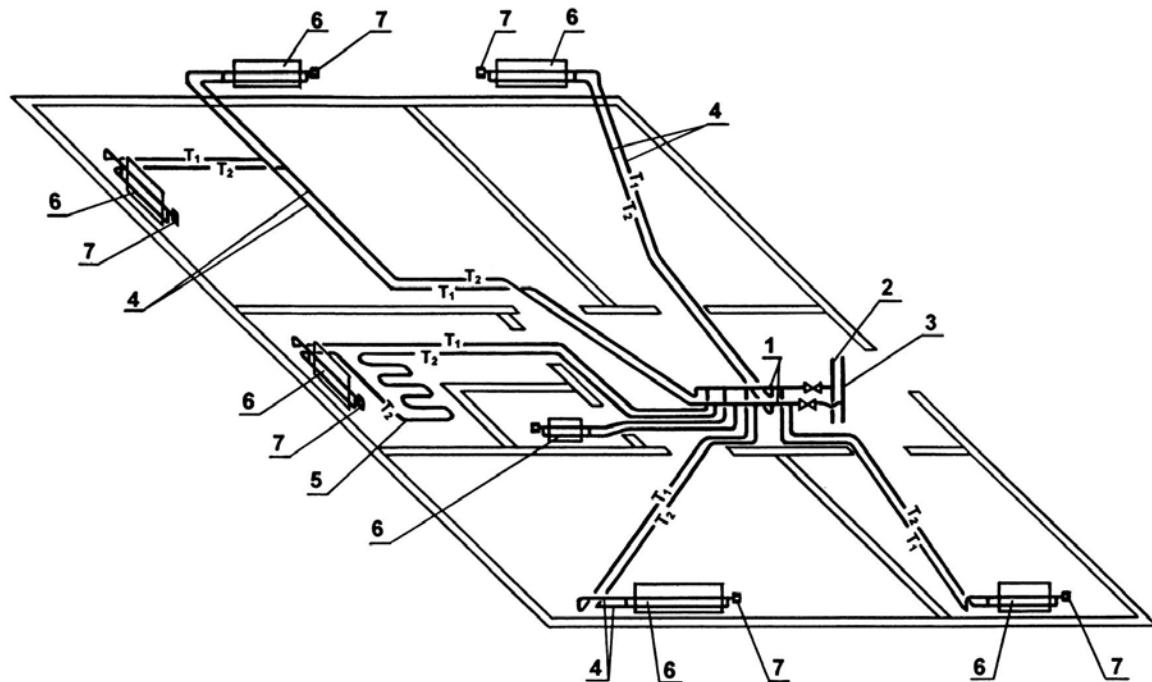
Лучевая схема напольной разводки теплопроводов от вертикальных стояков у внутренних стен: 1 – гребёнка, 2 – подающий стояк, 3 – обратный стояк, 4 – подающие теплопроводы, 5 – теплопроводы напольного отопления, 6 – конвекторы, 7 - термостаты
